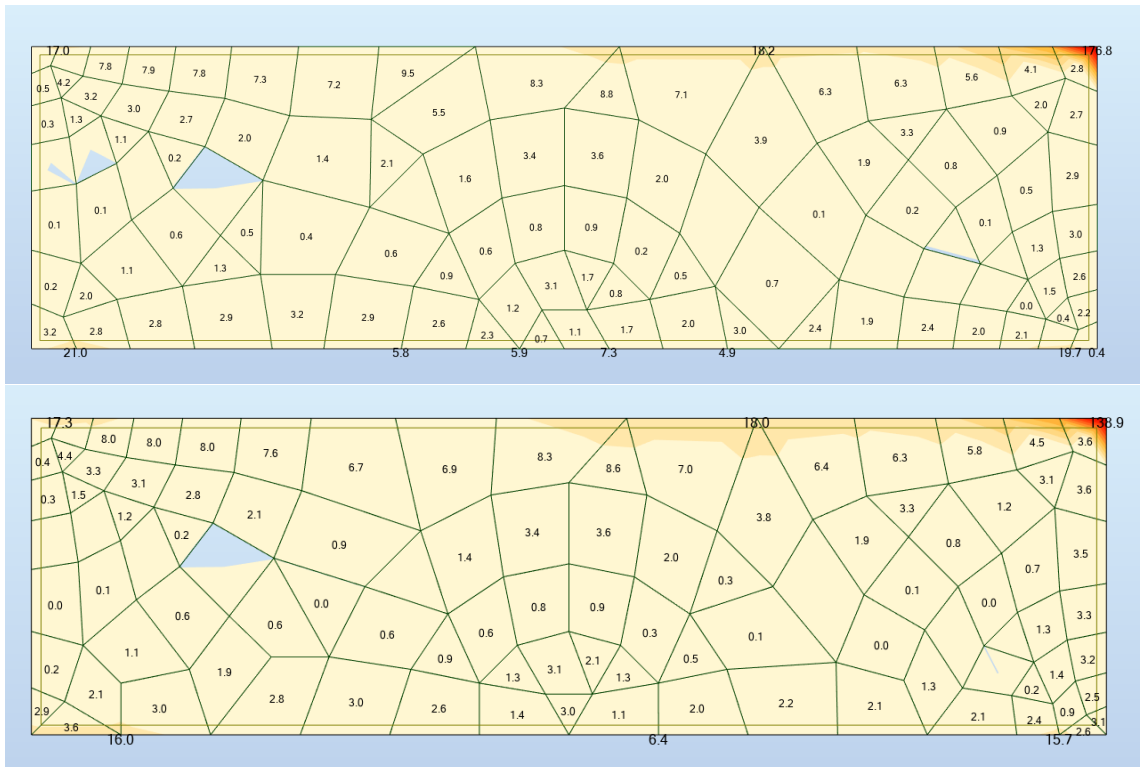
Cuantía horizontal exterior muro 18-31 (lado enterrado)
